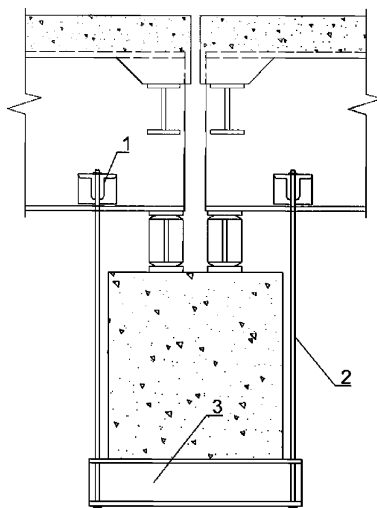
Анкерное устройство, предотвращающее подбрасывание опорных узлов пролетных строений: 1 – упорные уголки; 2 – анкерный стержень; 3 – анкерная балка
